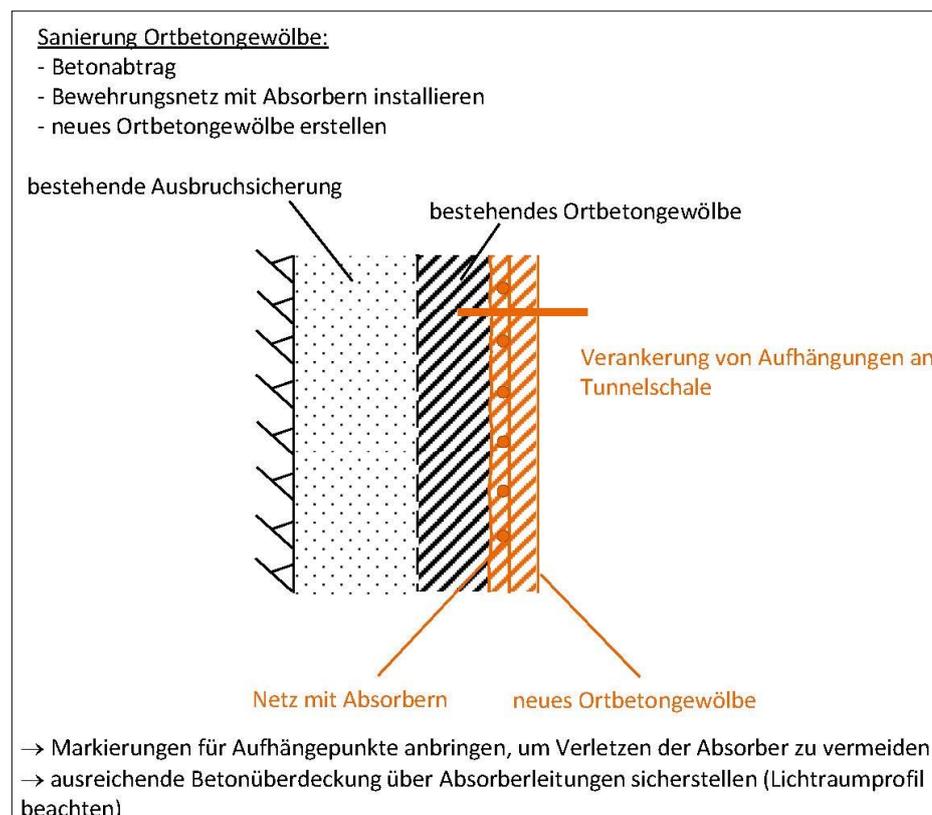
Prinzipschema Sanierung Ortbetongewölbe
